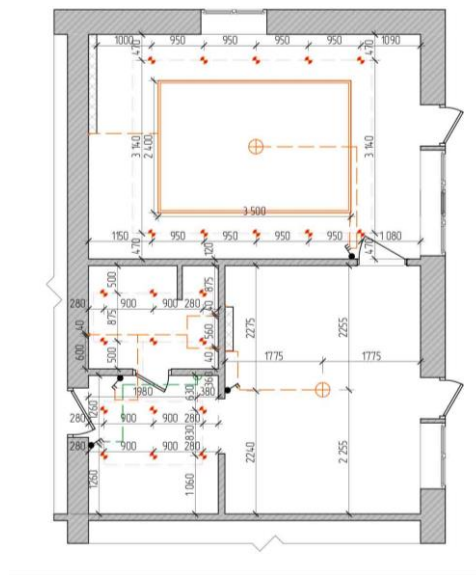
План расстановки осветительного оборудования 2-го этажа номера «Люкс»
